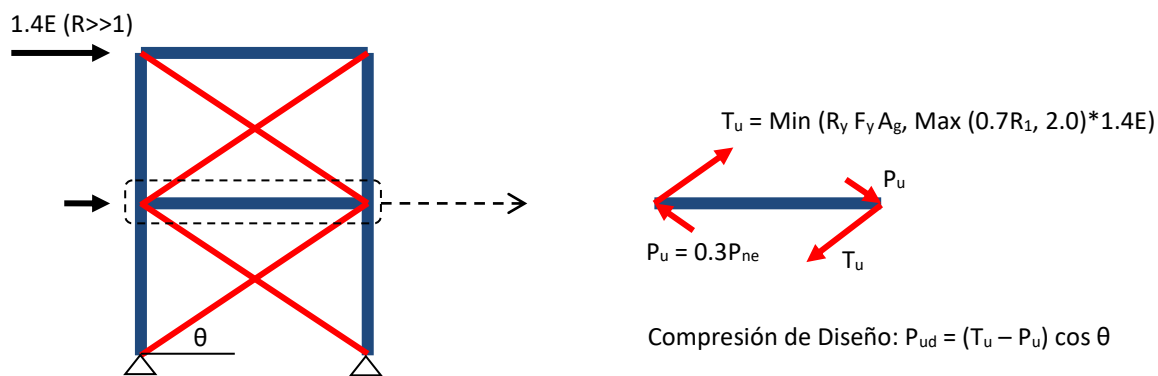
Equilibrio plástico (LRFD) sobre una viga puntal en un marco concéntricamente arriostrado.
